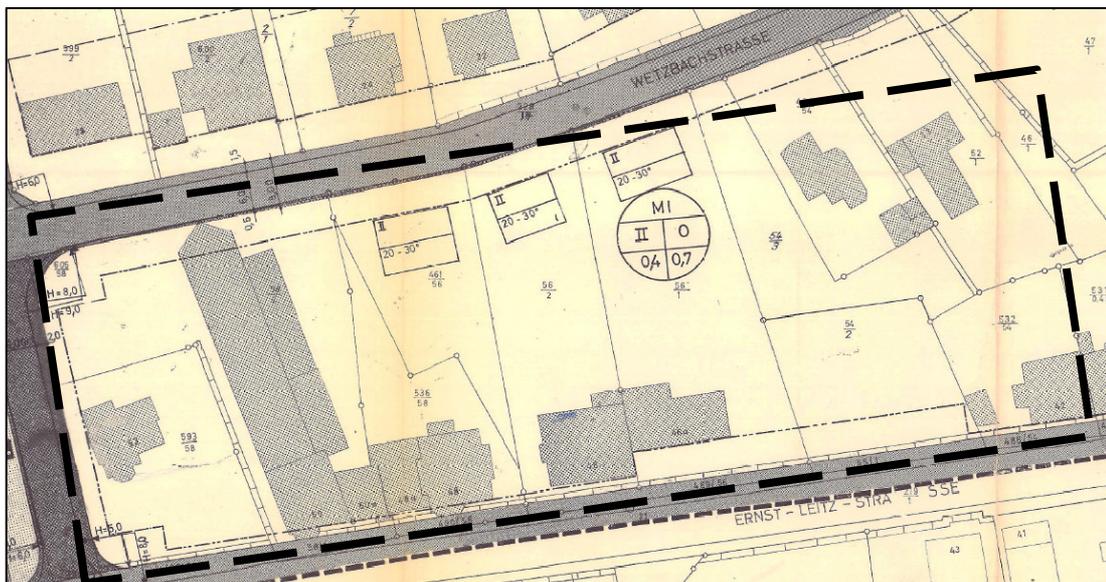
Auszug aus dem Bebauungsplan (Ursprungsplan) / Bereich der 2. Änderung
